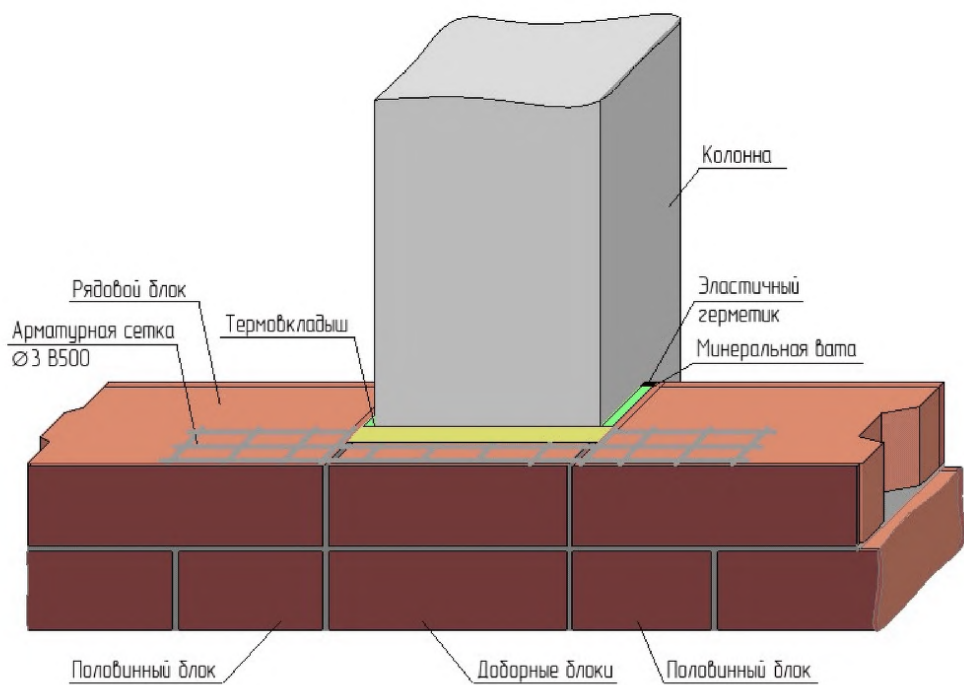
Пример сопряжения стены с железобетонной колонной.
